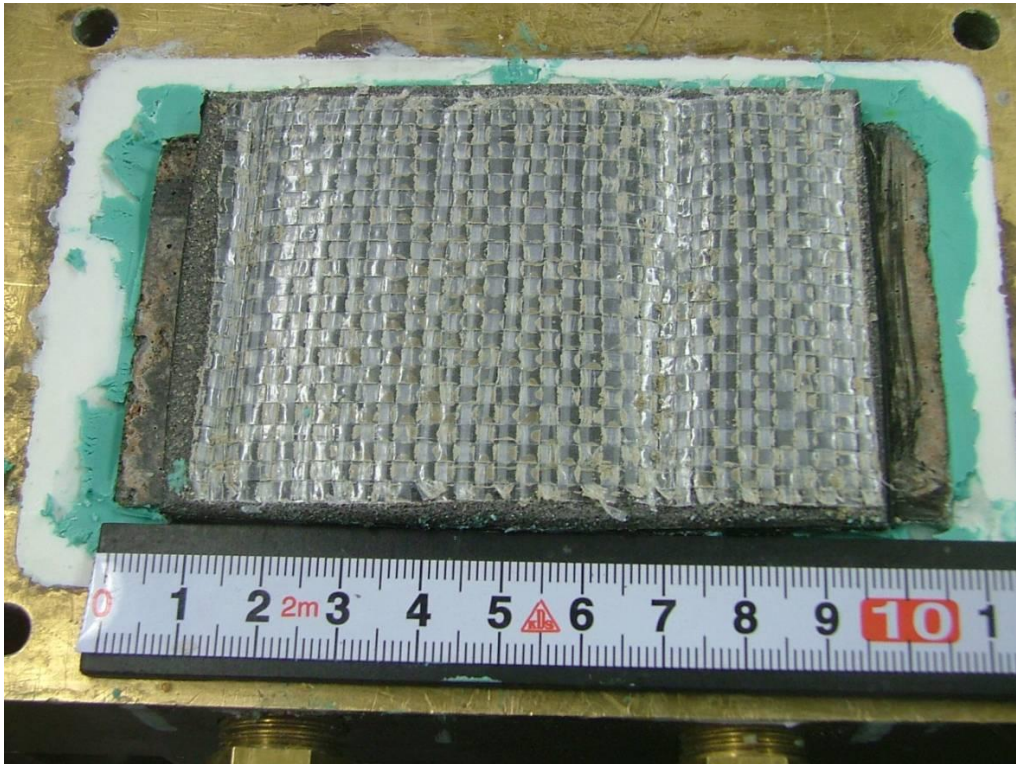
一方向載荷試験 一方向載荷試験後の供試体状況
